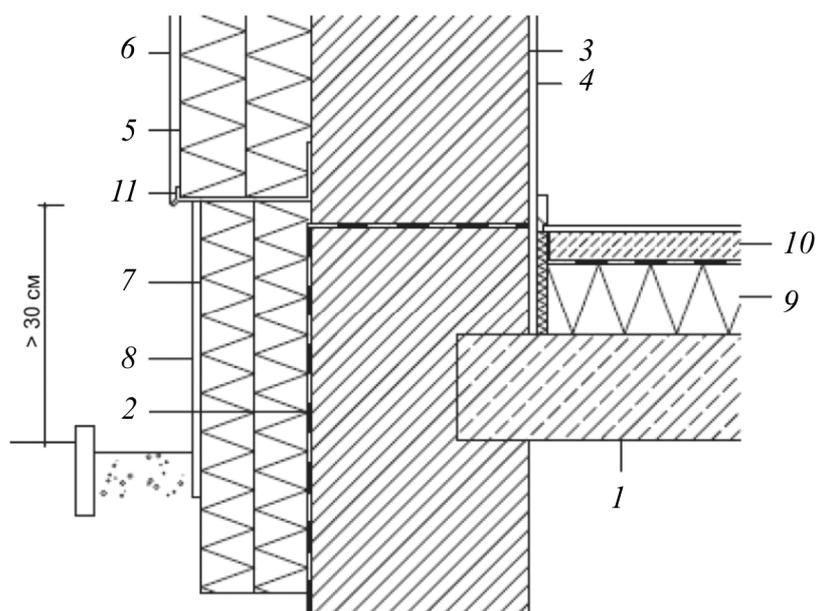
Схема утепления стыка перекрытия с наружной стеной здания:
